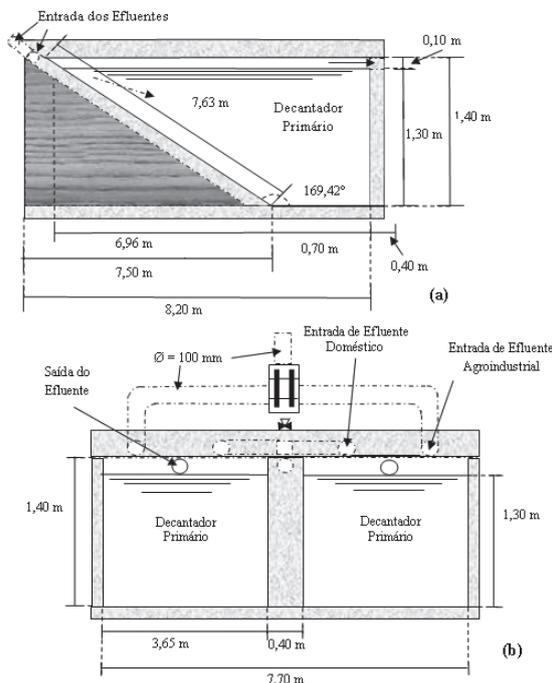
Proposta de decantadores primários: (a) Corte AA'; (b) Corte BB'
